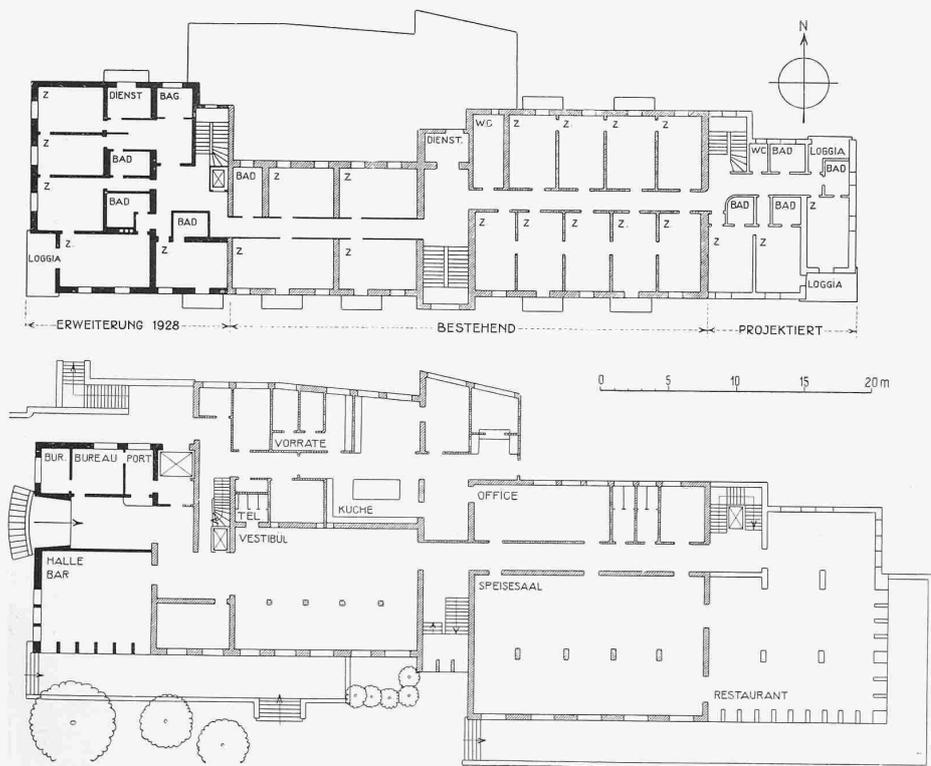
u. 6. Grundrisse 1 : 500.
